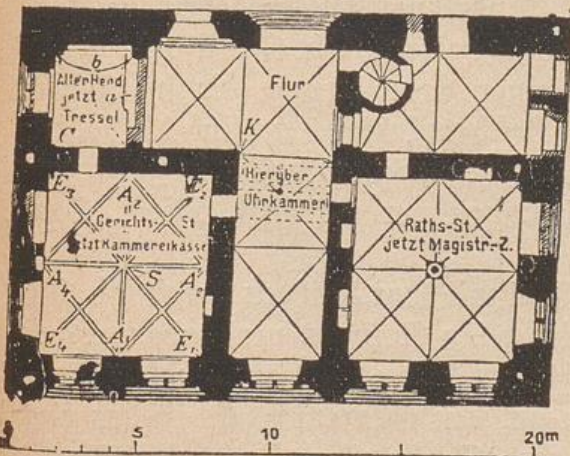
Rathaus zu Marienburg in Westpreußen. Grundriß des Obergeschosses.
